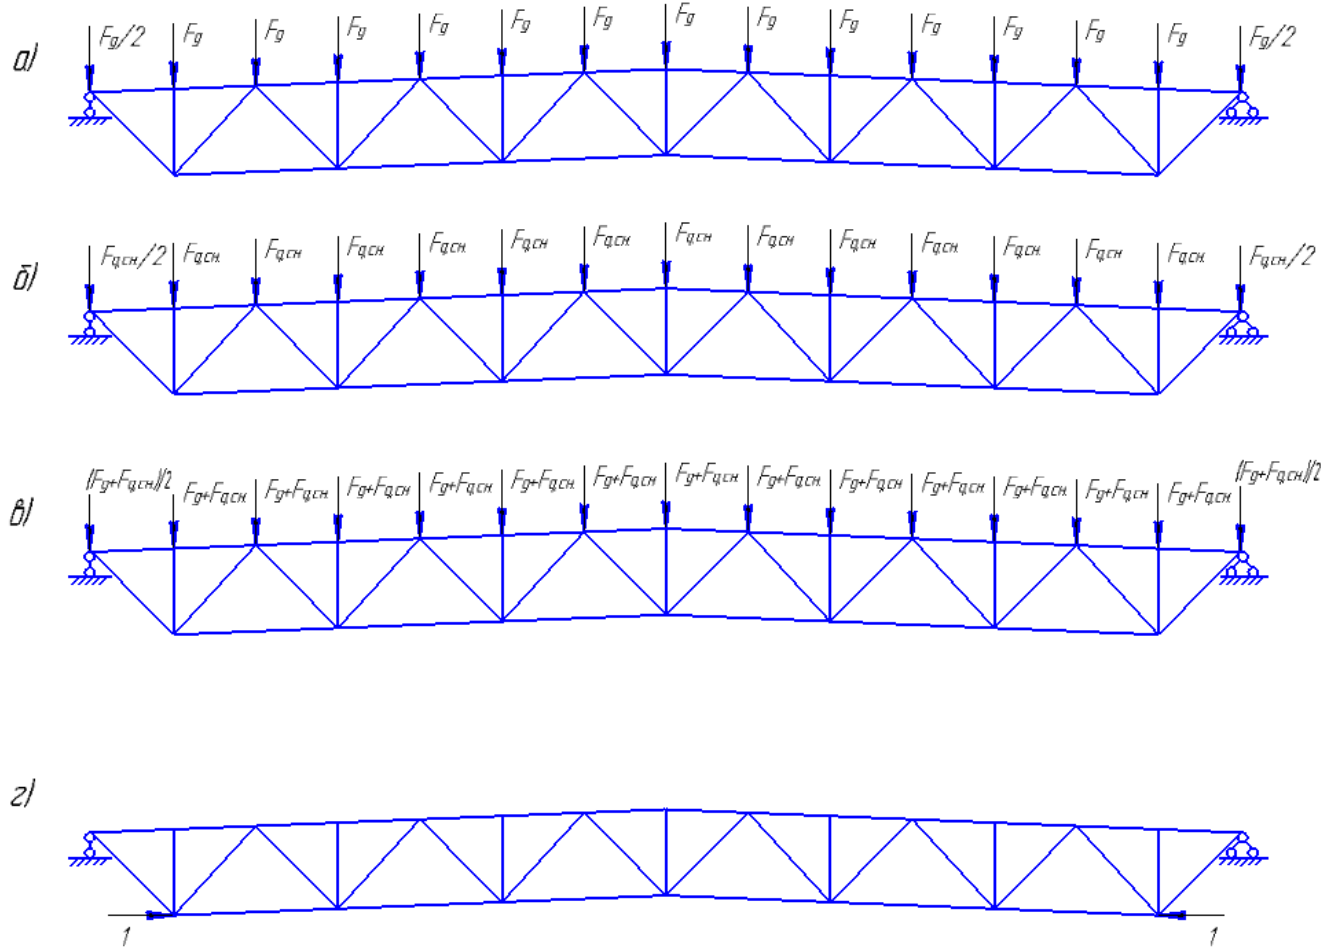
а) Схема приложения нагрузки от собственного веса покрытия; б) Схема приложения нагрузки от снега; в) Основная система от внешней нагрузки; г) Основная система от единичного усилия в затяжке
